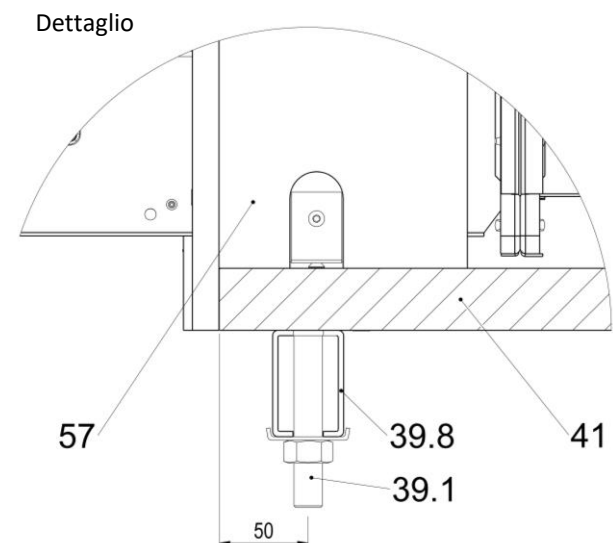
collegamento canale BKA-EN con controltaio tipo ERA2 distanziato dalla parete massiccia
